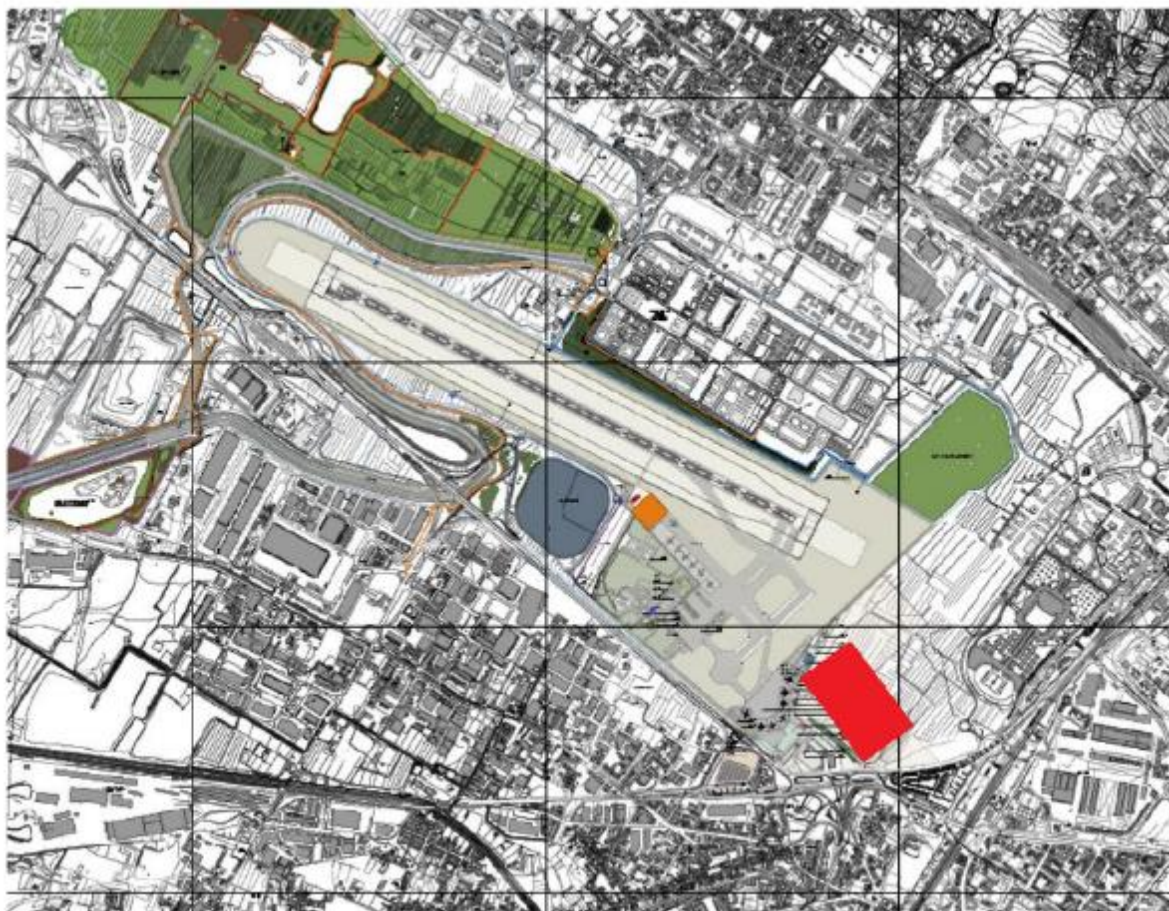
Planimetria della pista 12-30 con indicazione del nuovo terminal su sedime est (in rosso)
